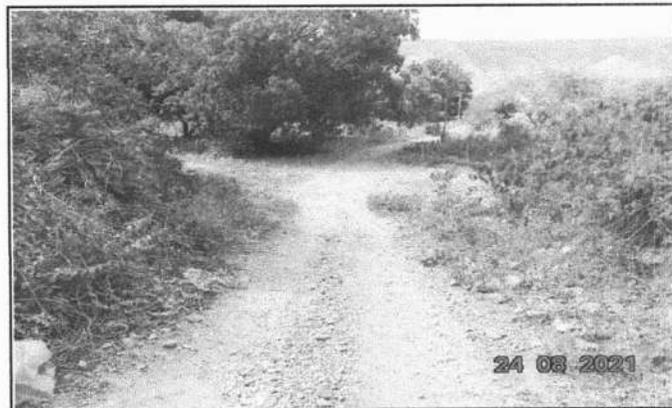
LOCAL DA CONSTRUÇÃO - BUEIRO
